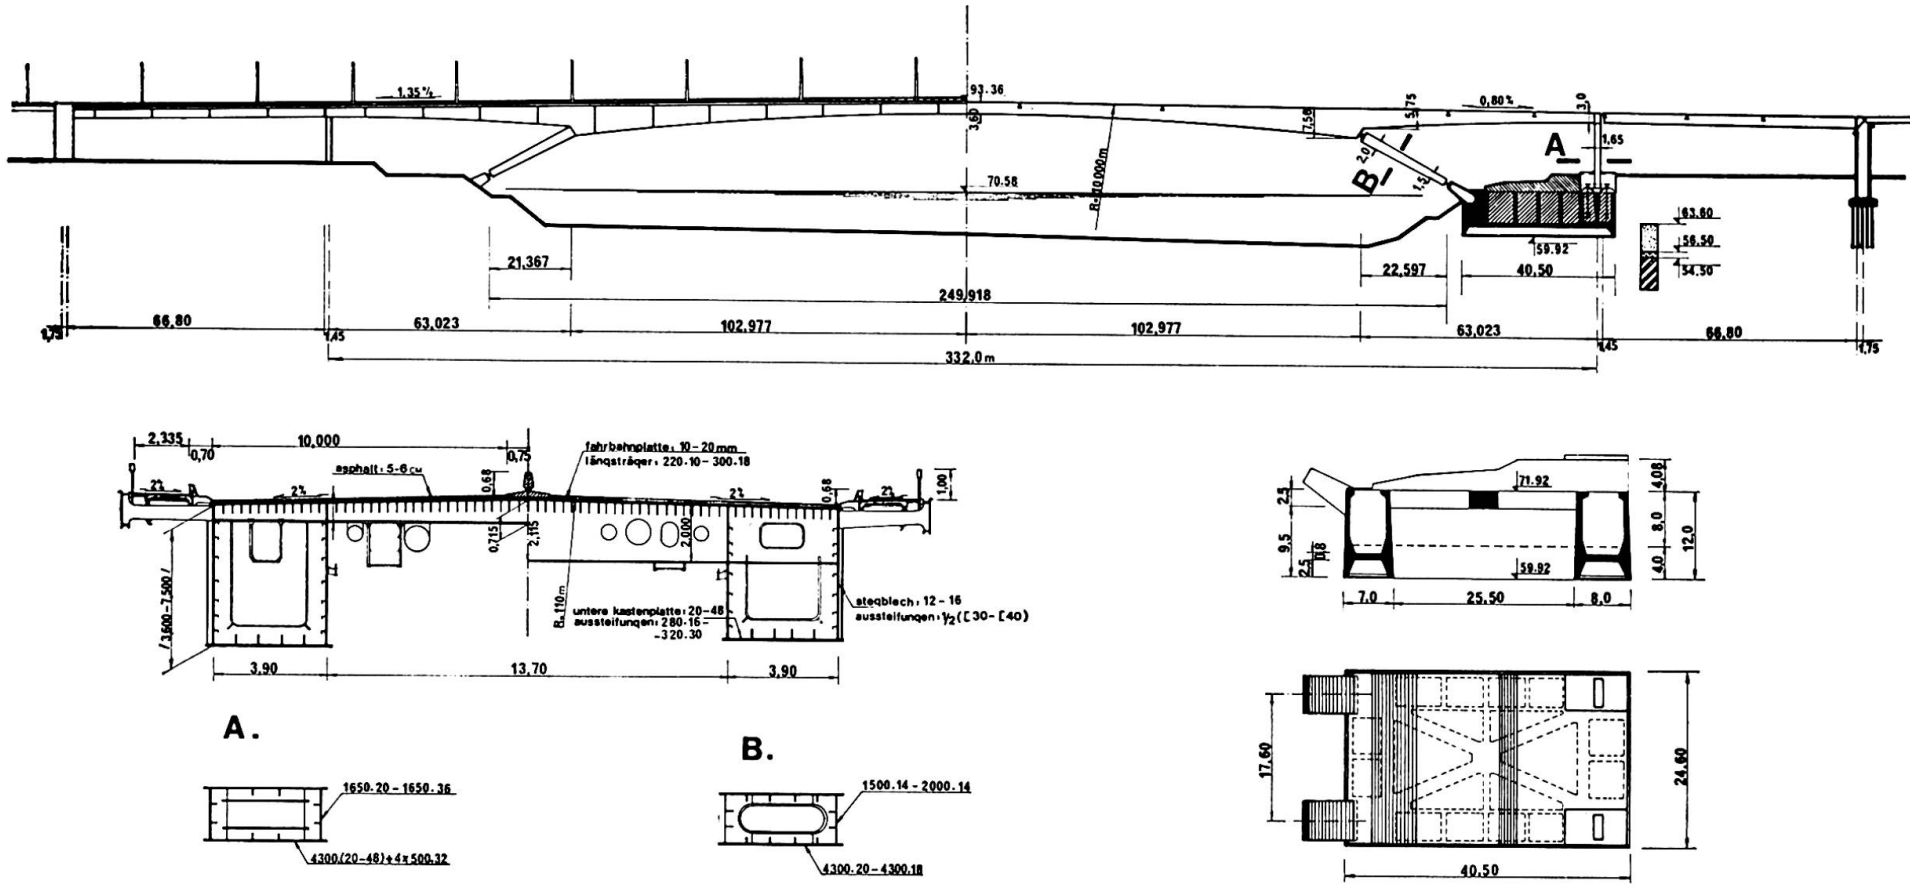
Die Aussicht, der Längsschnitt und die Querschnitte der Stahlkonstruktion und der Grundriss mit den Längsschnitt des Senkkastens der Brücke
